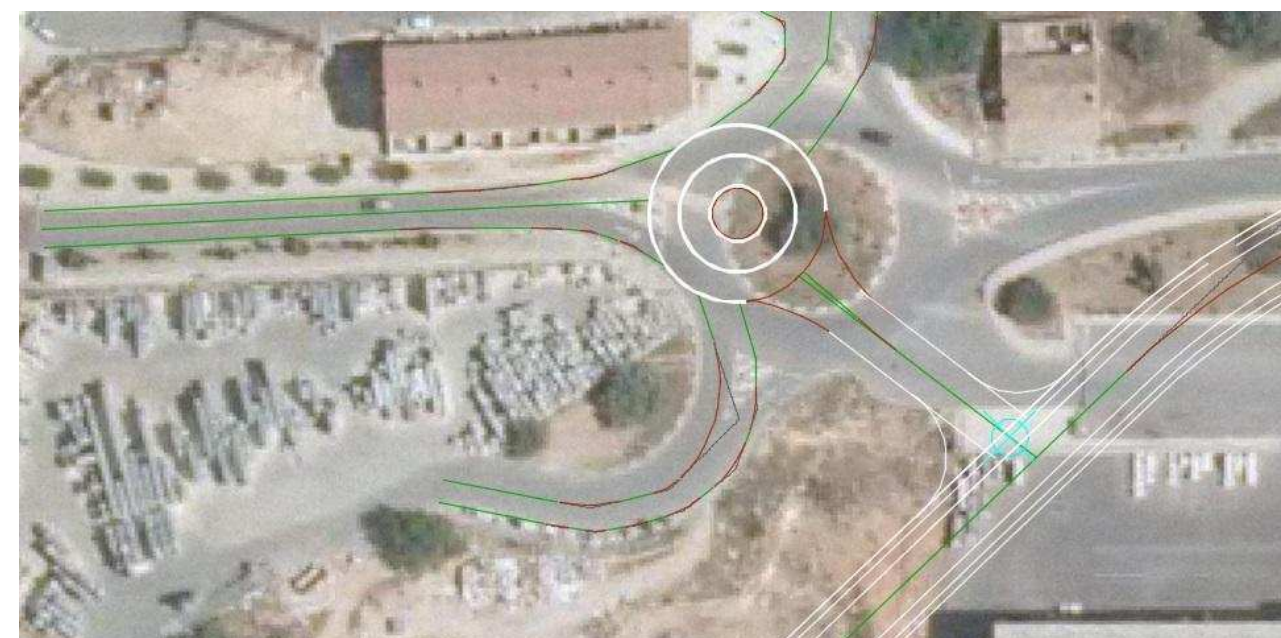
Rotonda alternativa sur, enlace este (Fuente: Jorge Planells)
